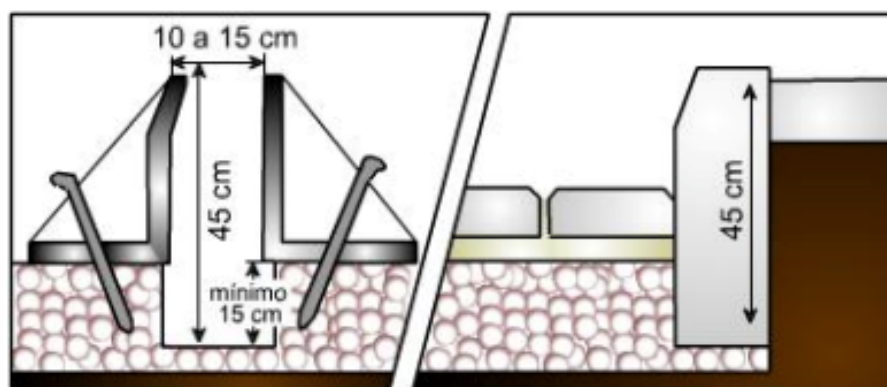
Guia de concreto moldada *in loco* para confinamento do pavimento⁴⁹
